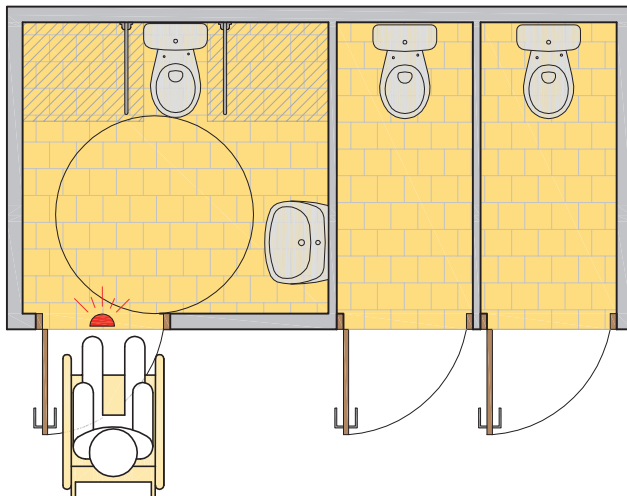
Planta de un aseo de uso público accesible con inodoro y lavabo.
